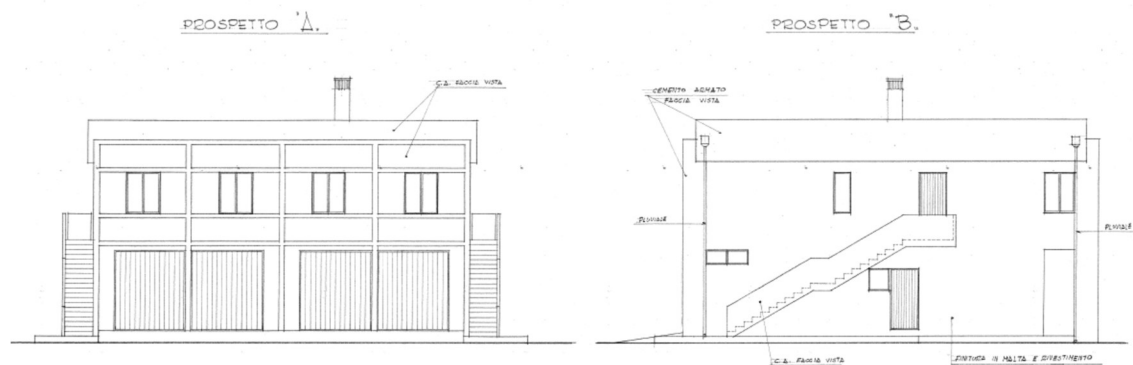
Progetto di esecutivo del 1985 – Prospetti
